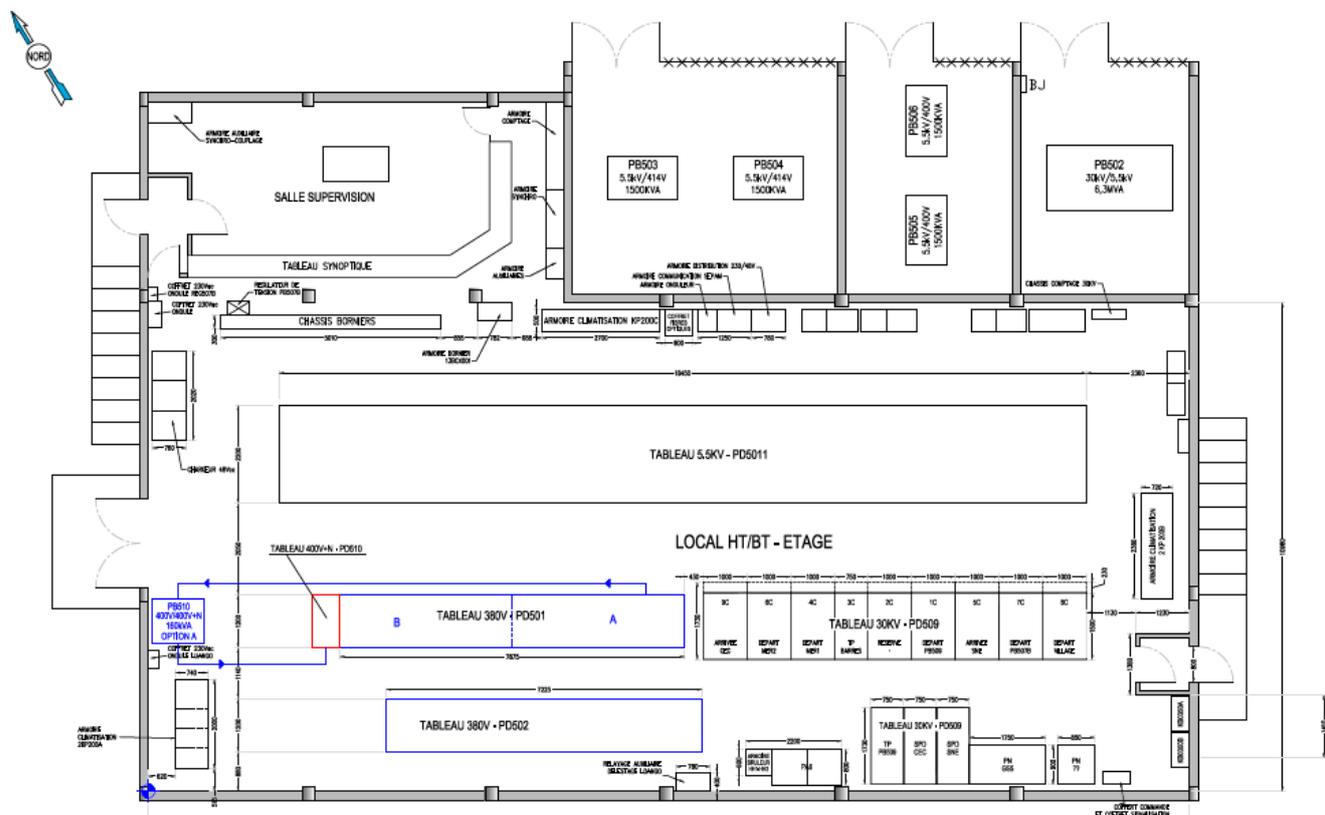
Plan d'implantation des tableaux BT et du transfo PB510
